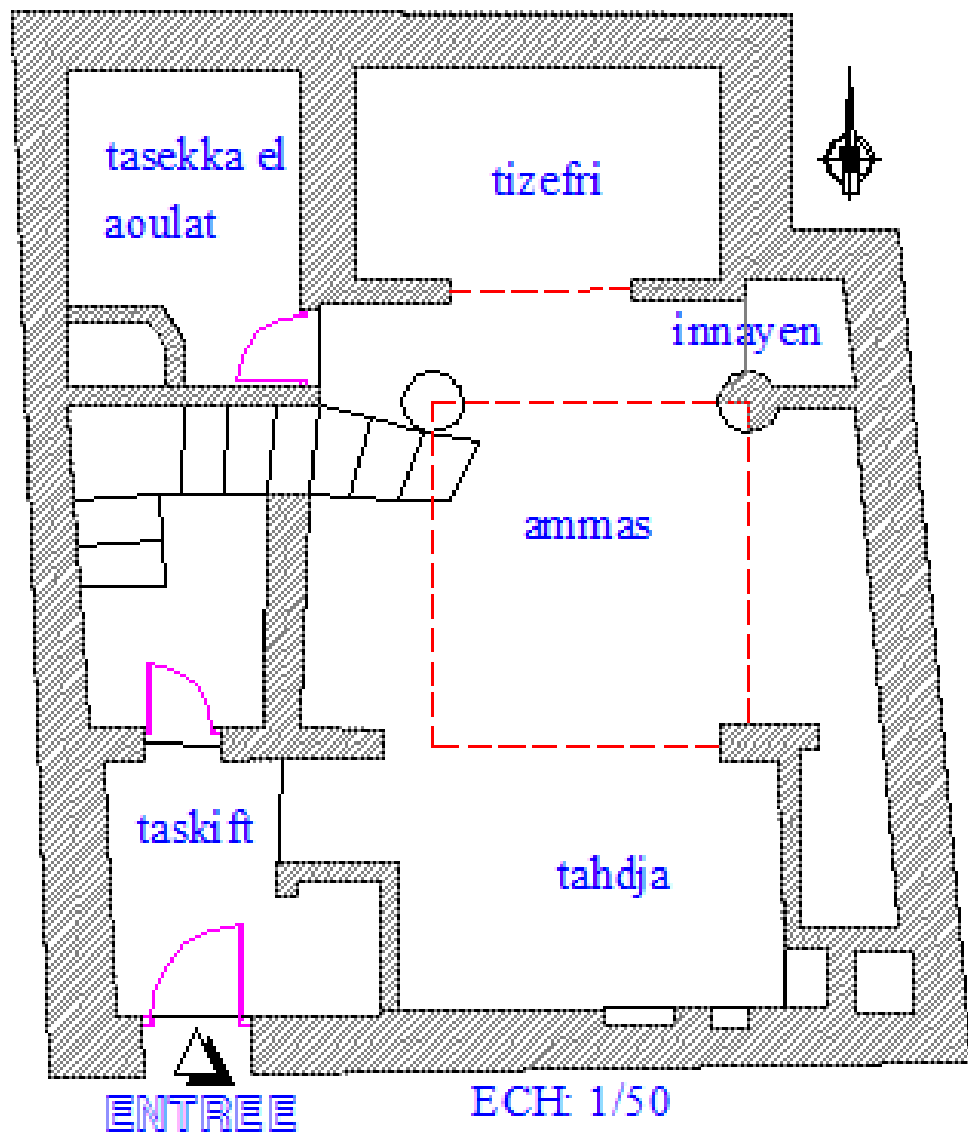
plan de masse, l'Echantillon n°01.
